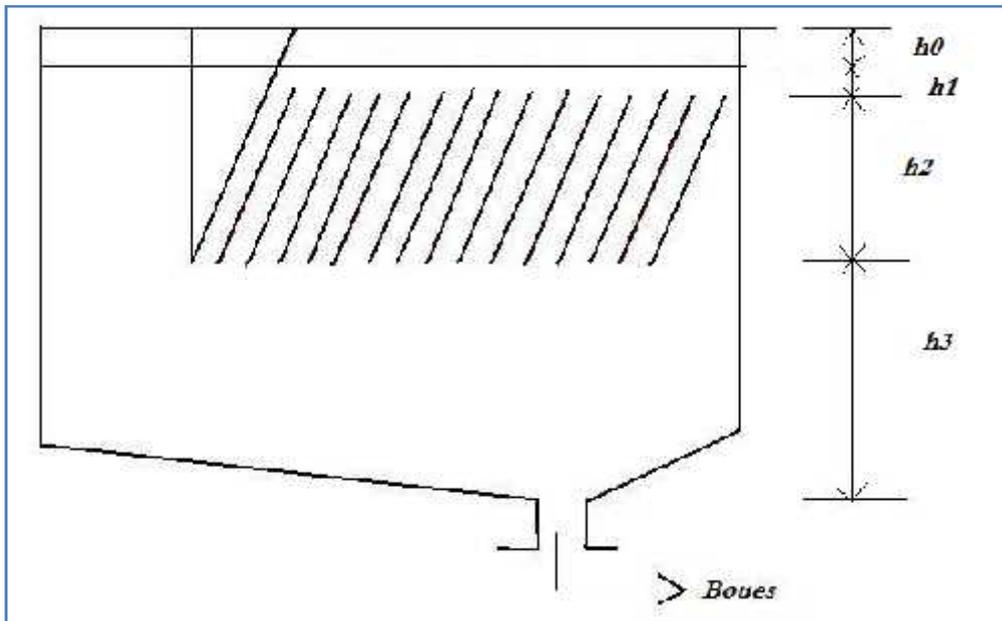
Les hauteurs d'un décanteur lamellaire [13].
